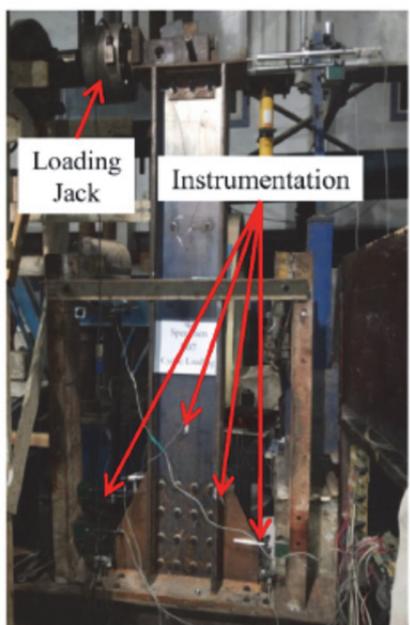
Испытания колонны из ЛСТК [Fig. 9. Tests of a light steel thin-walled column profile] [34]
